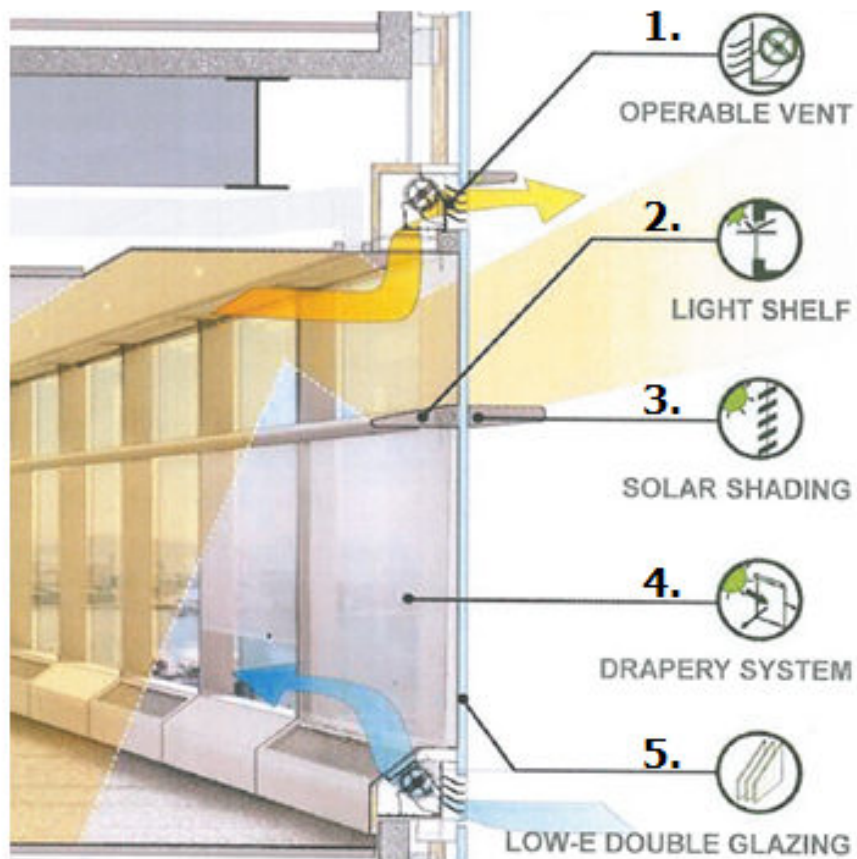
Tower Curtain Wall (Foto: Handout Gartner)
